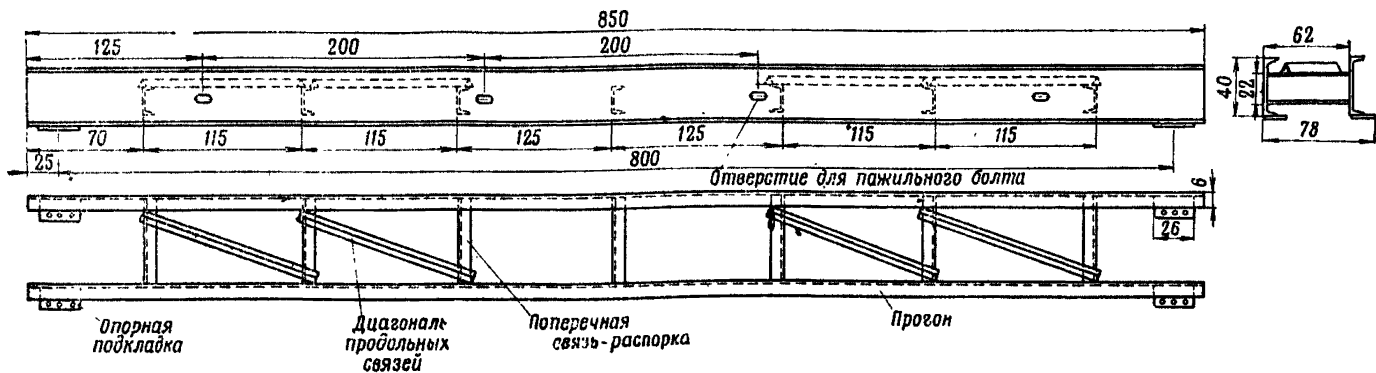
Блок в составе двух прогонов из швеллеров с металлическими сварными связями
